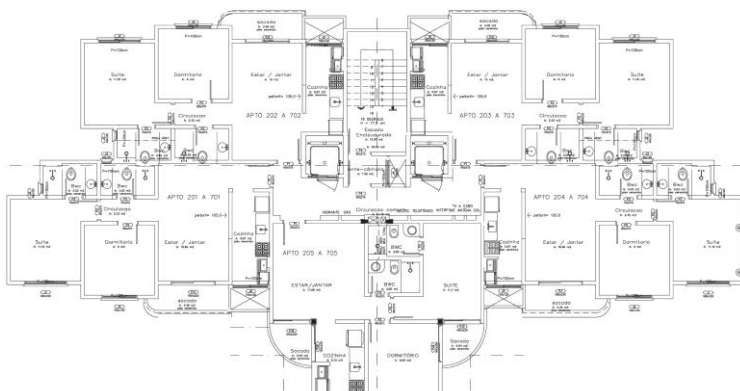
Planta baixa do pavimento tipo do Edifício Puerto Madero, do segundo ao sétimo pavimento. Fonte: Bolzan (2002)
